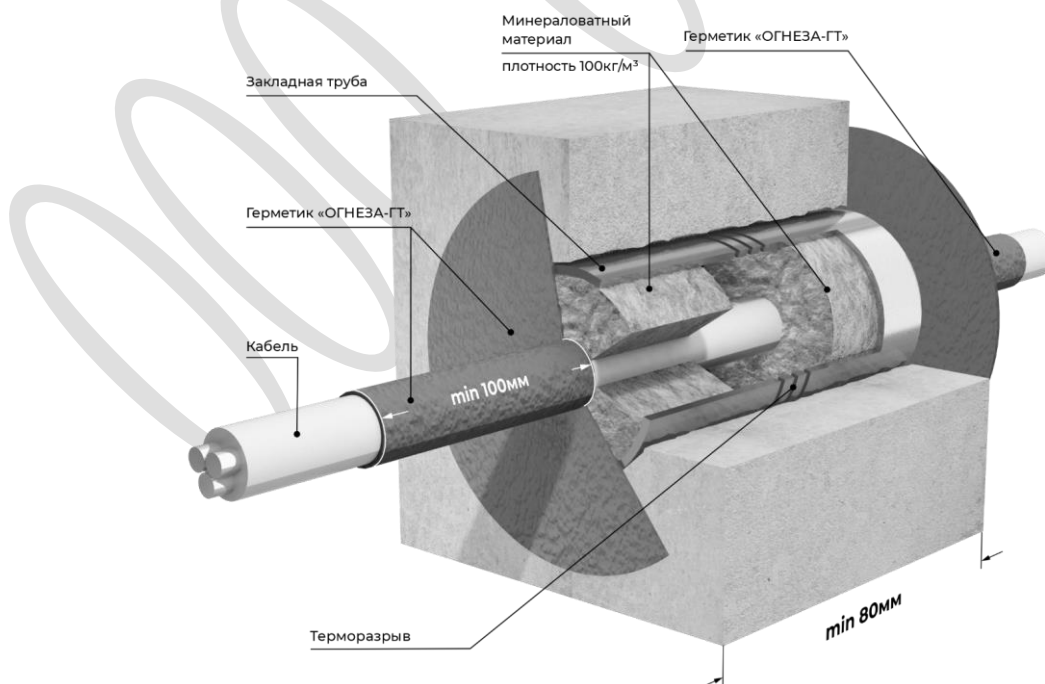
Монтаж кабельной проходки в закладной трубе с использованием герметика «ОГНЕЗА-ГТ» для стен и перекрытий толщиной от 80 мм (IET 60)
